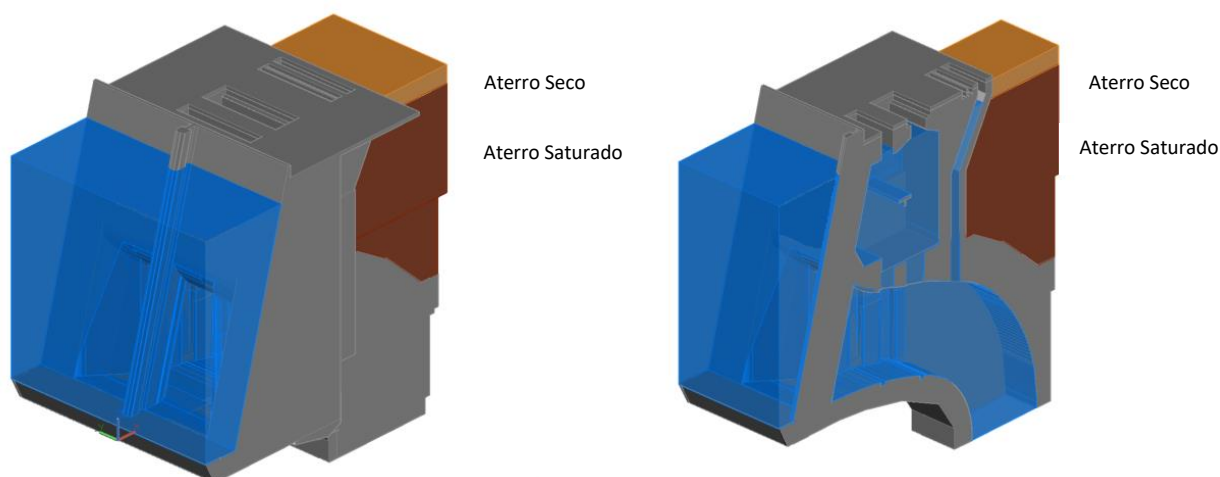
Modelo tridimensional do cenário 2 (vista geral e corte)
